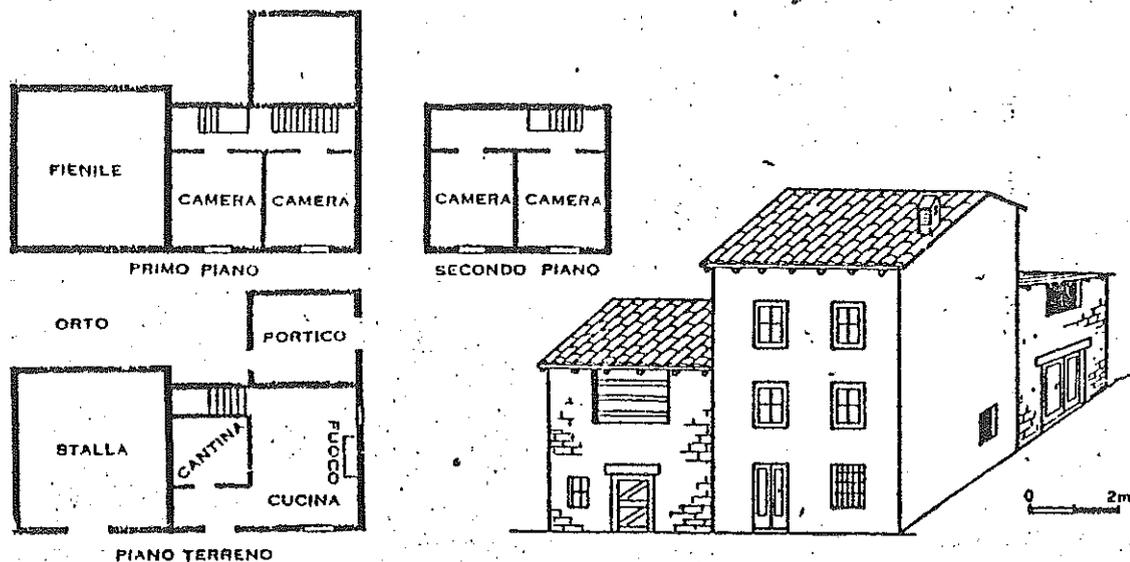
Prospetto e planimetria di dimora con rustico e *pòrtek* giustapposti in Cerano (Valle Intelvi).
